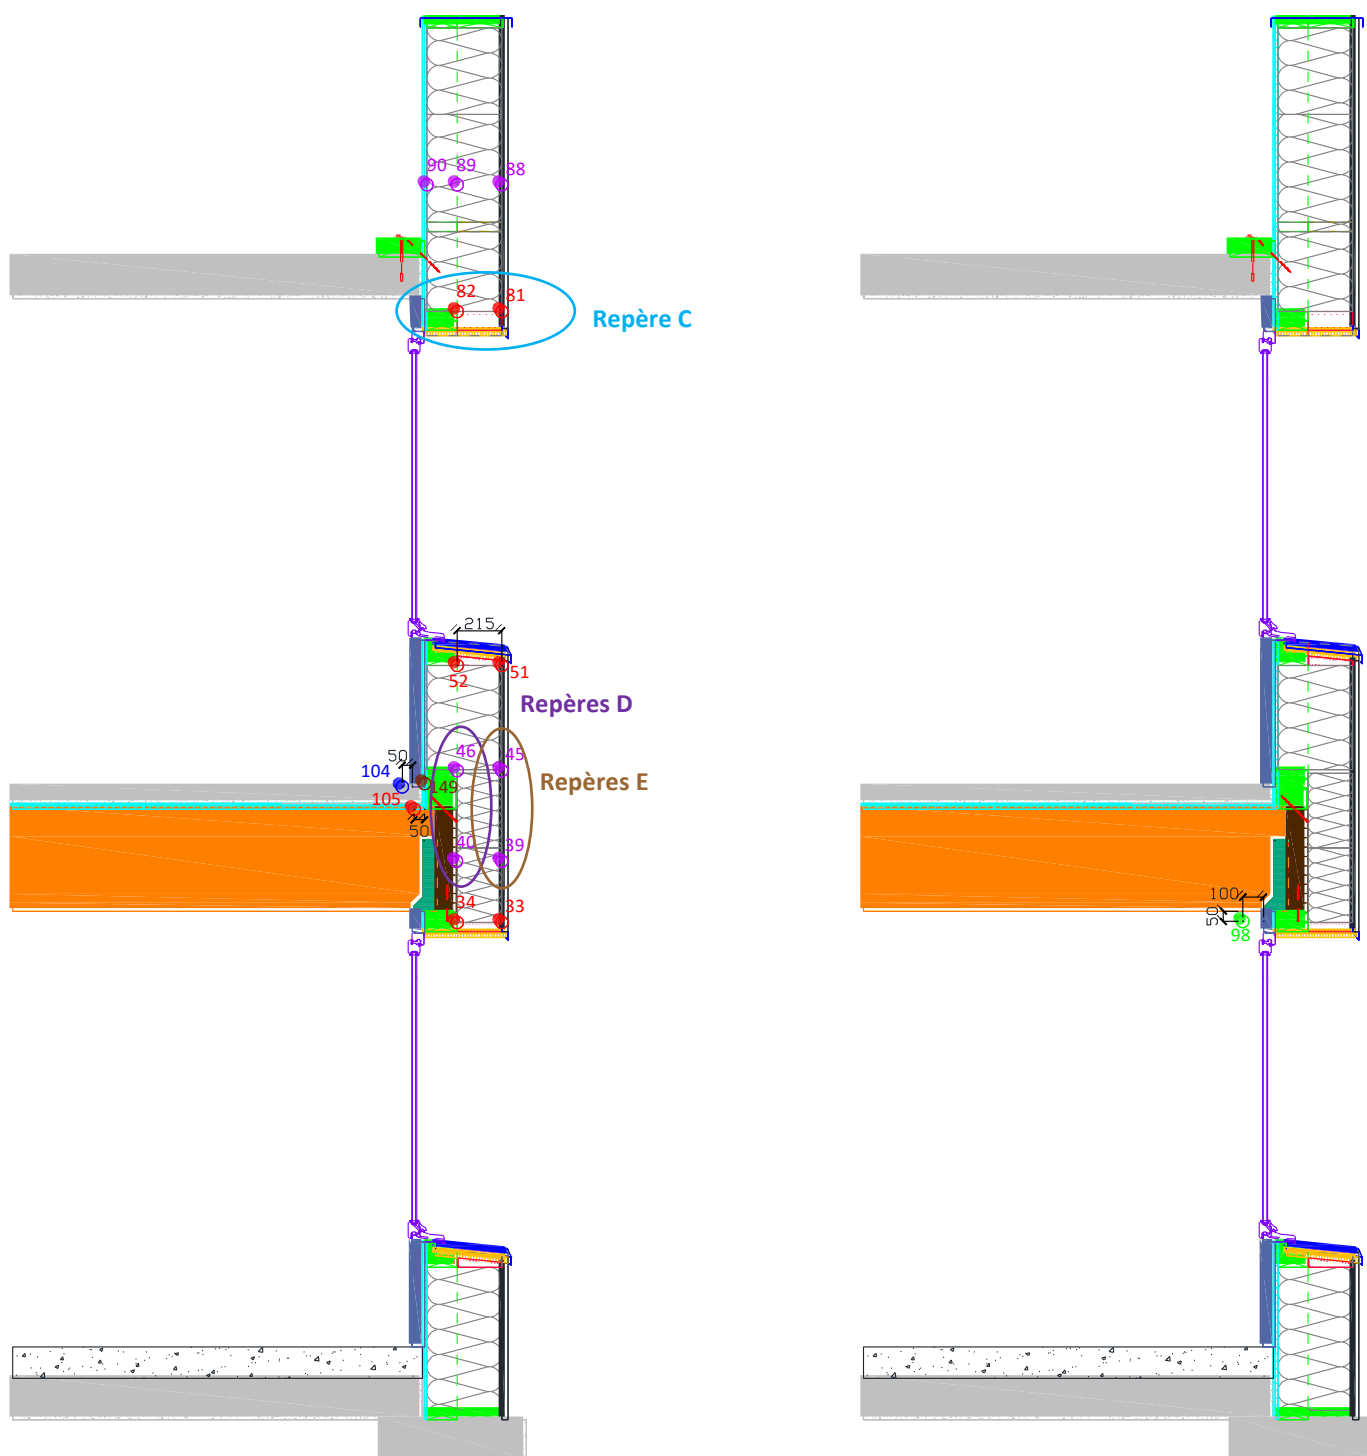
Instrumentation de l'élément de façade - (A gauche) : Coupe C-C - (A droite) : Coupe D-D
